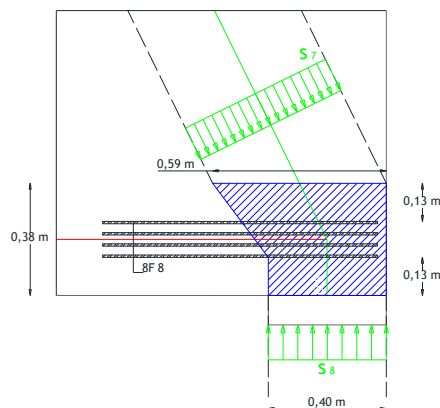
Geometria do nó singular NS2 relativo à zona junto do aparelho de apoio do lado direito da viga parede.
